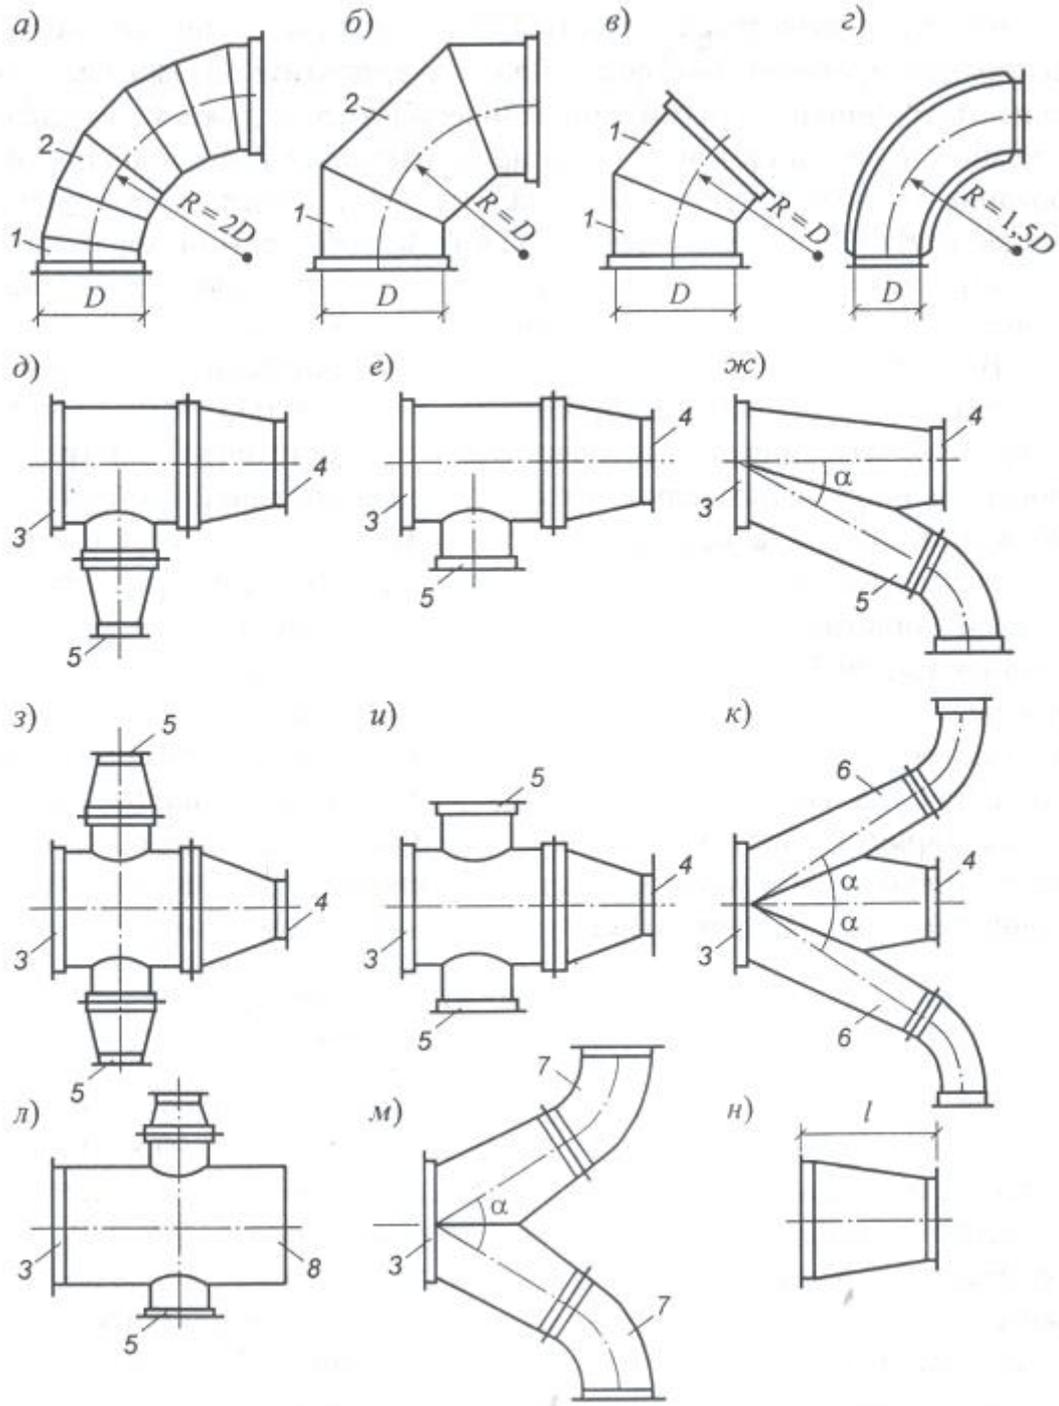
Фасонные части круглых стальных воздуховодов.
